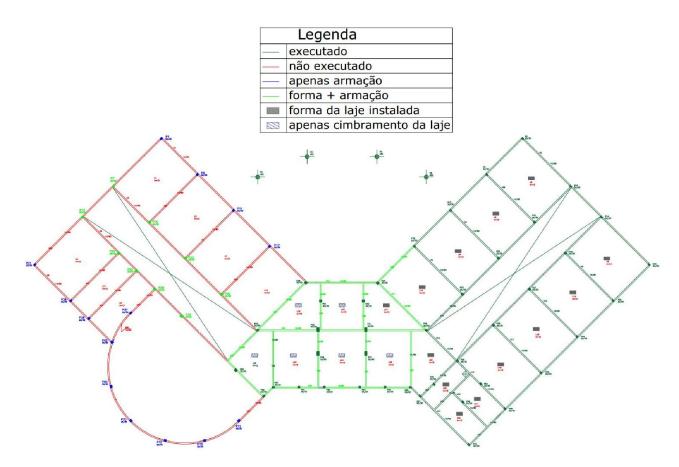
Mapa iluminado pavimento de cobertura.
